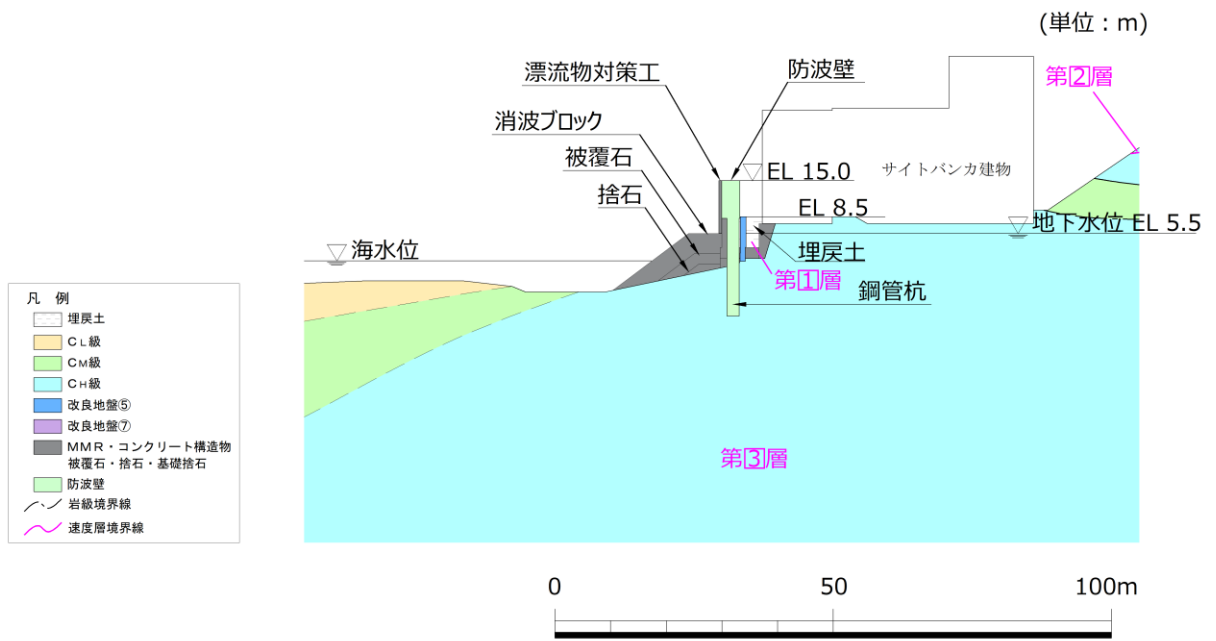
評価対象断面図 (⑤-⑤断面)
